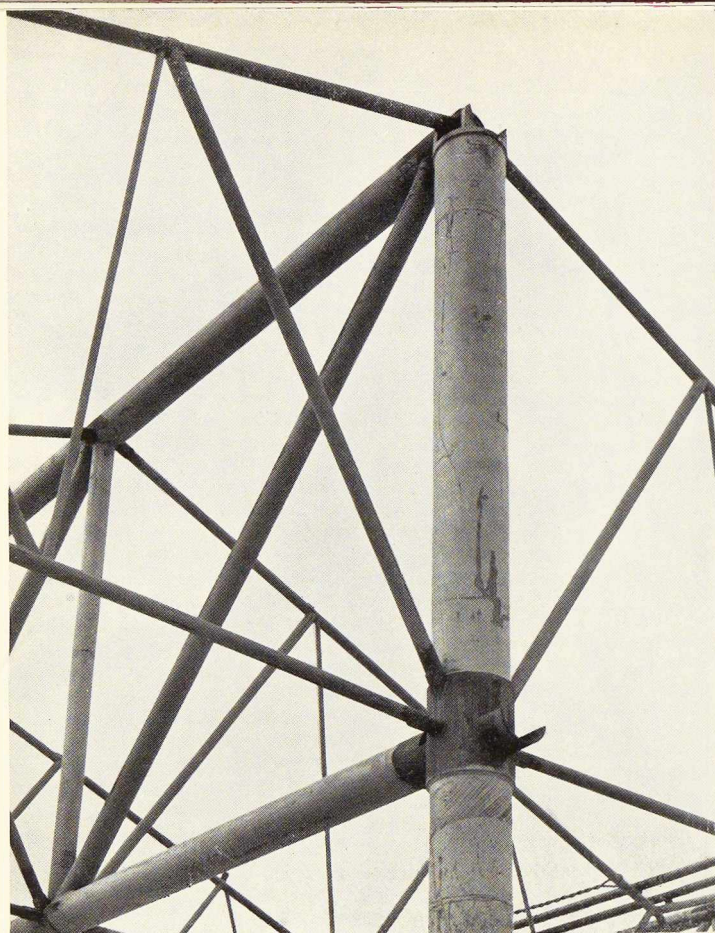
Usines Tubewrights. Charpente de l'atelier principal. Détail de l'assemblage d'une maîtresse-poutre et d'une colonne.
